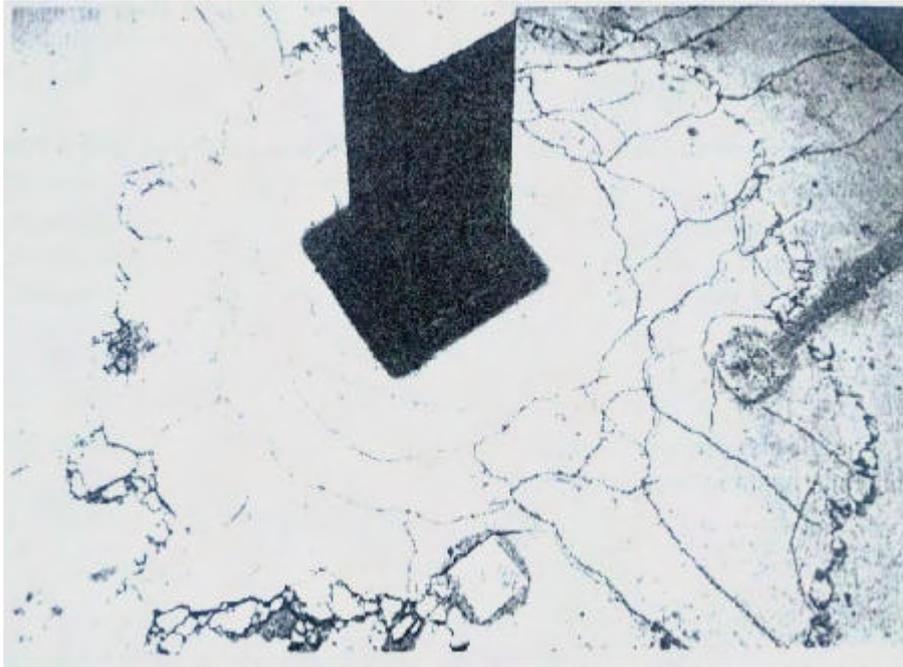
Fissuras de puncionamento em uma laje armada. FONTE: CÁNOVAS (1994).
